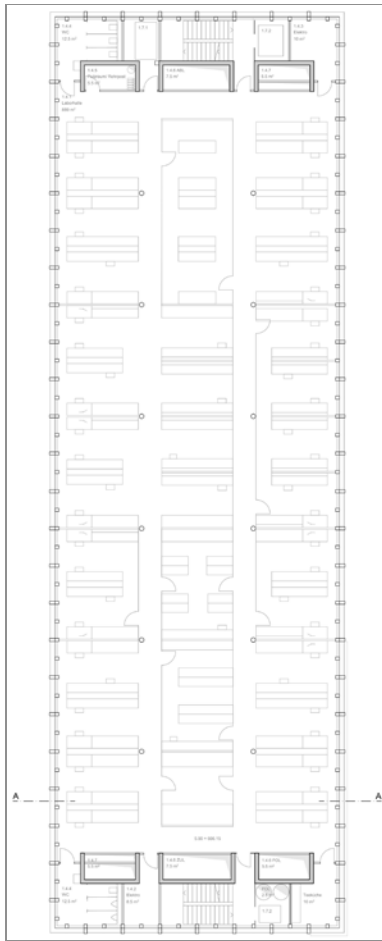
Grundriss Erdgeschoss
